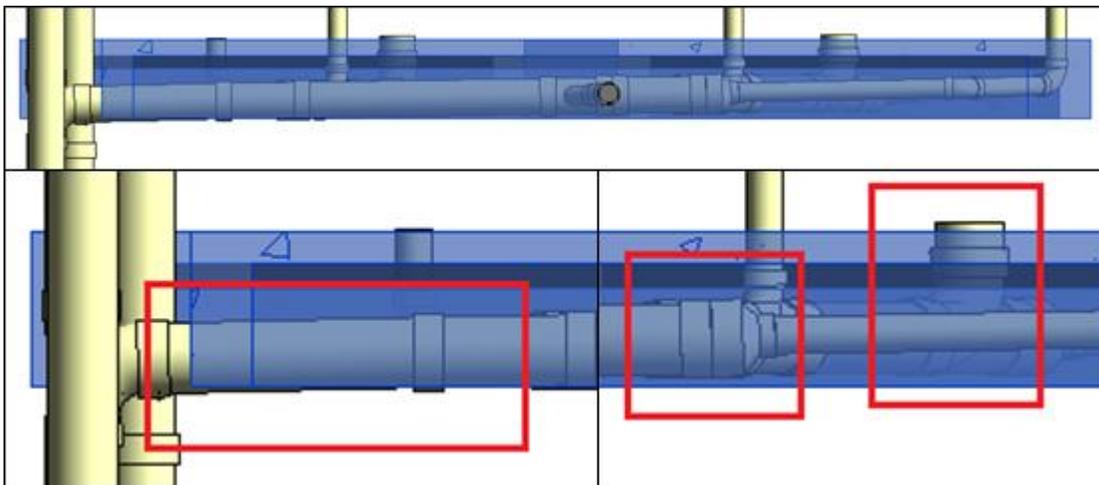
Vista transversal de tuberías de A.N. en planta alta.
